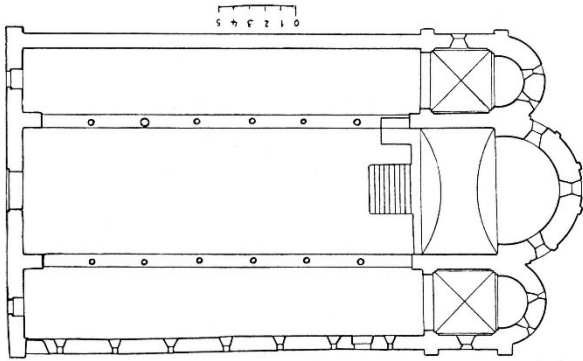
Grundriss von San Pietro in Agliate
